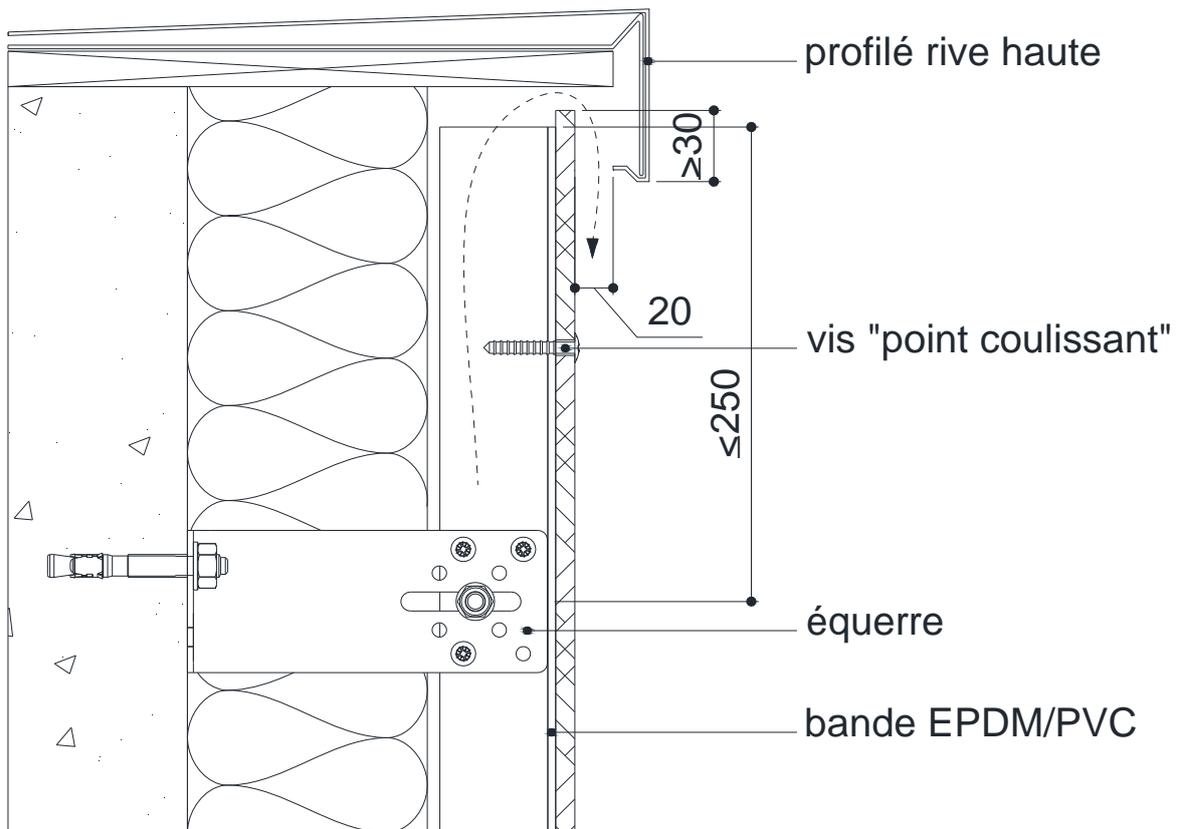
Détail arrêt sur acrotère sur ossature bois ou (cote en mm)
